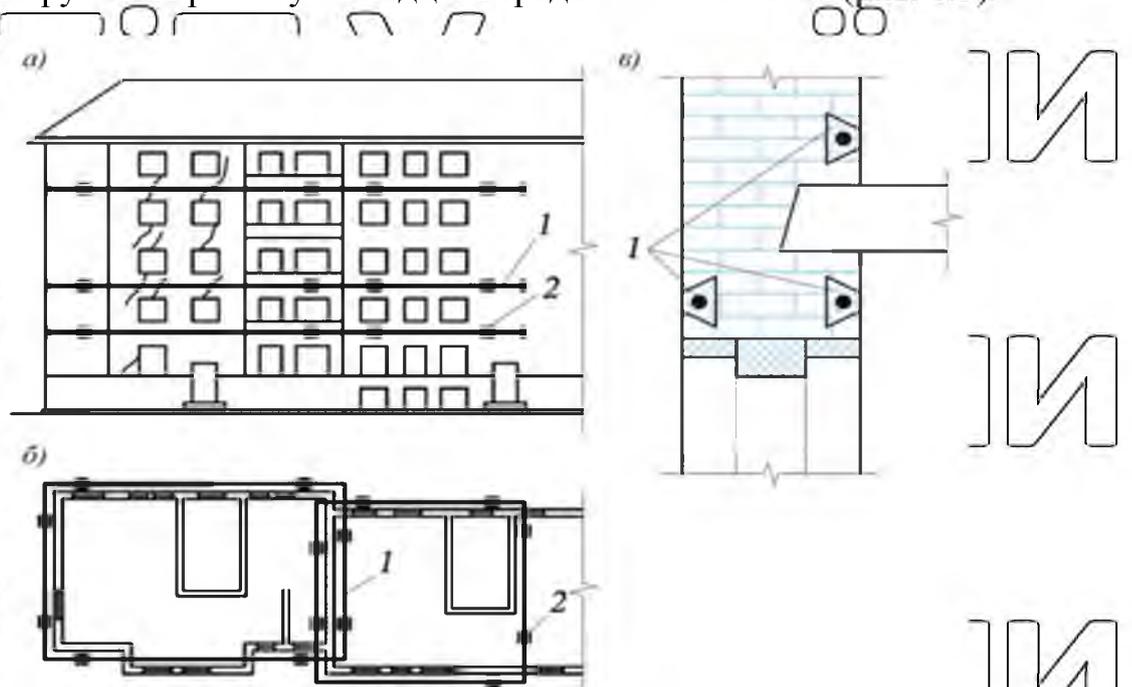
Конструкції підсилення з напруженими поясами: а - фасад; б - план частини будівлі; в - варіанти розміщення тяжів; 1 - арматурний тяж діаметром 22 - 32 мм; 2 - штраба
